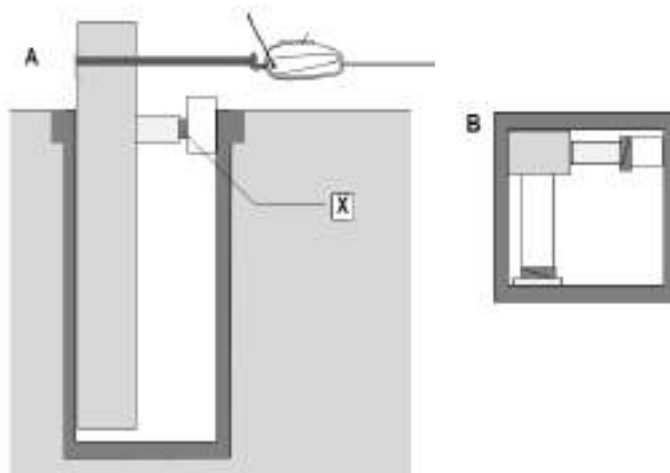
Aufriss einer Verankerung an der hinteren Schachtwand (A) mit Verkeilung (X) und dessen Grundriss (B).
